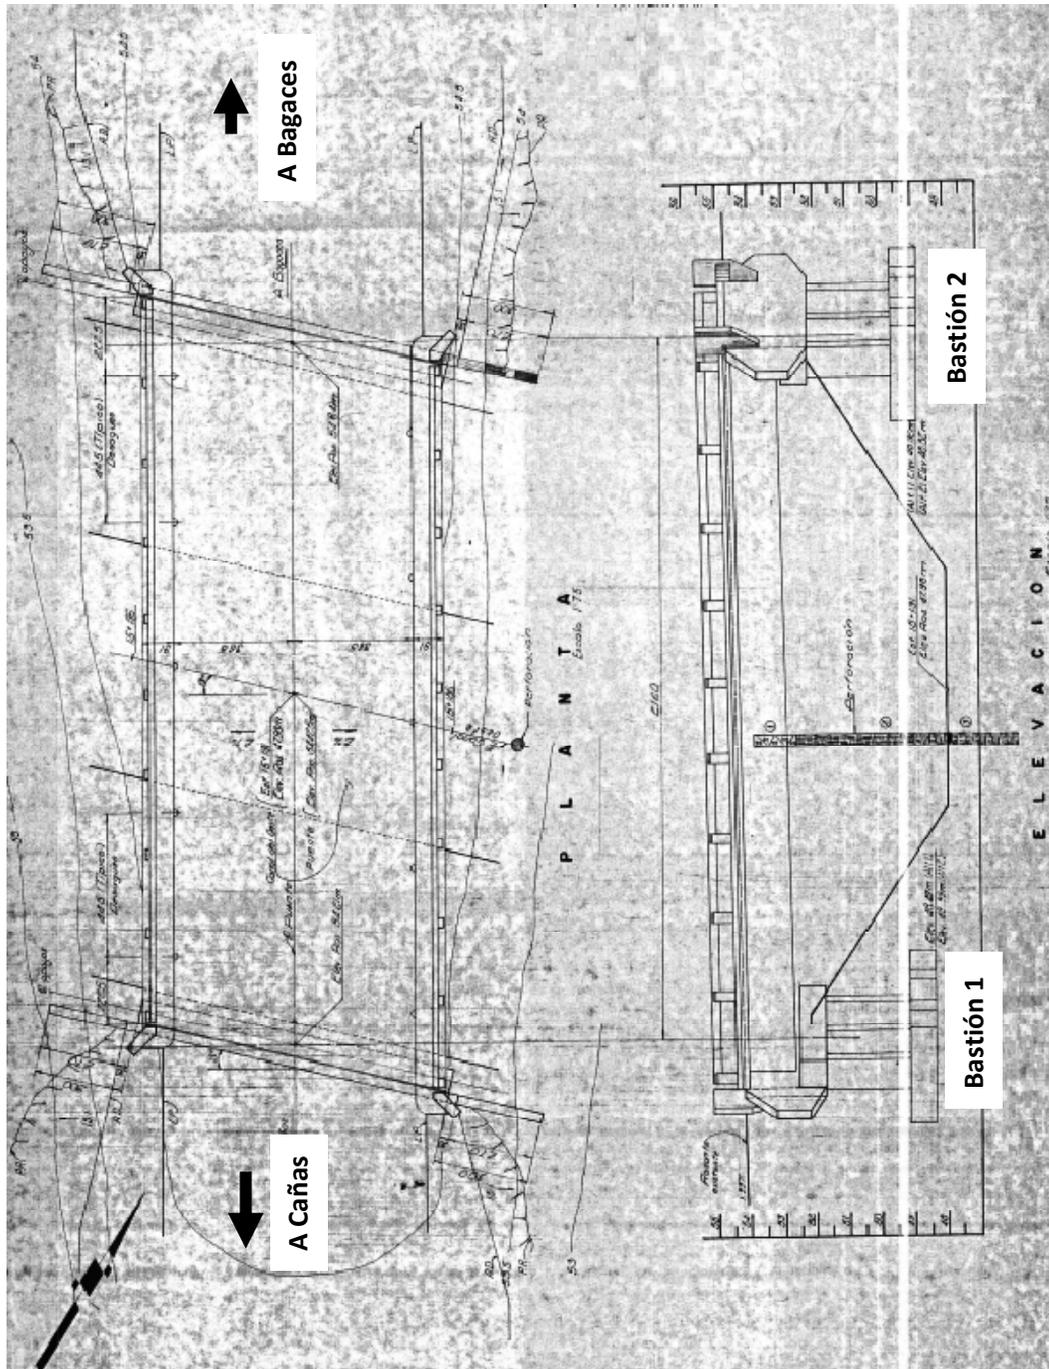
Vista en planta y elevación en planos estructurales y nomenclatura utilizada para la identificación de los distintos componentes del puente sobre el Canal de Riego Oeste.
